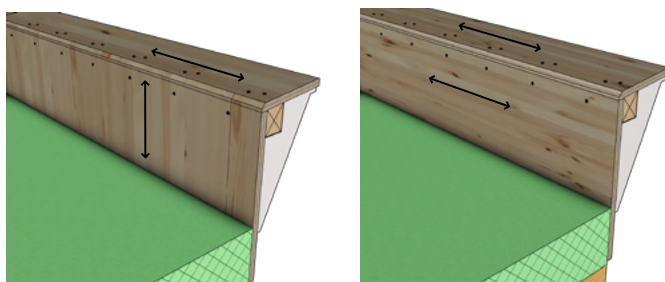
Perspective des constructions d'acrotères en panneaux de 27 mm, avec indication du sens des fibres.
